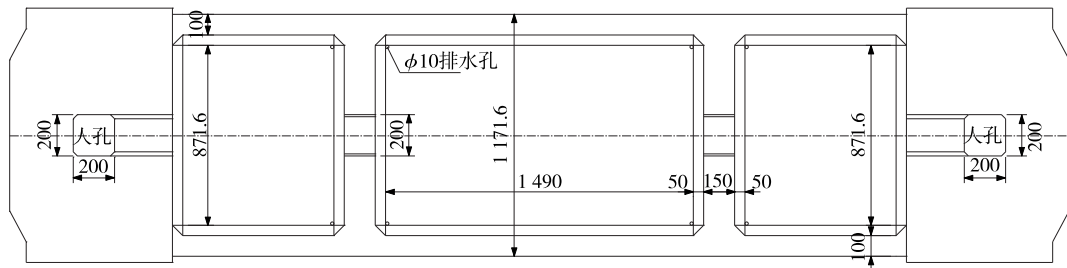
主塔下横梁平面图(0—0 截面, 单位:cm)
